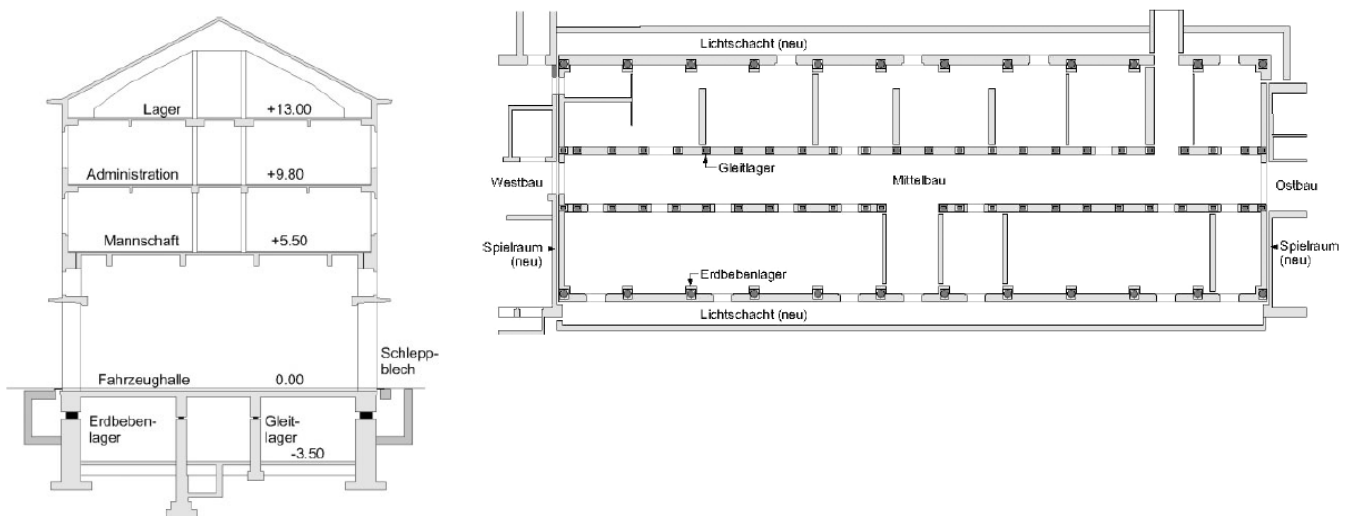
Grundriss Kellergeschoss und Querschnitt mit Erdbebenlagern und Gleitlagern [11]
